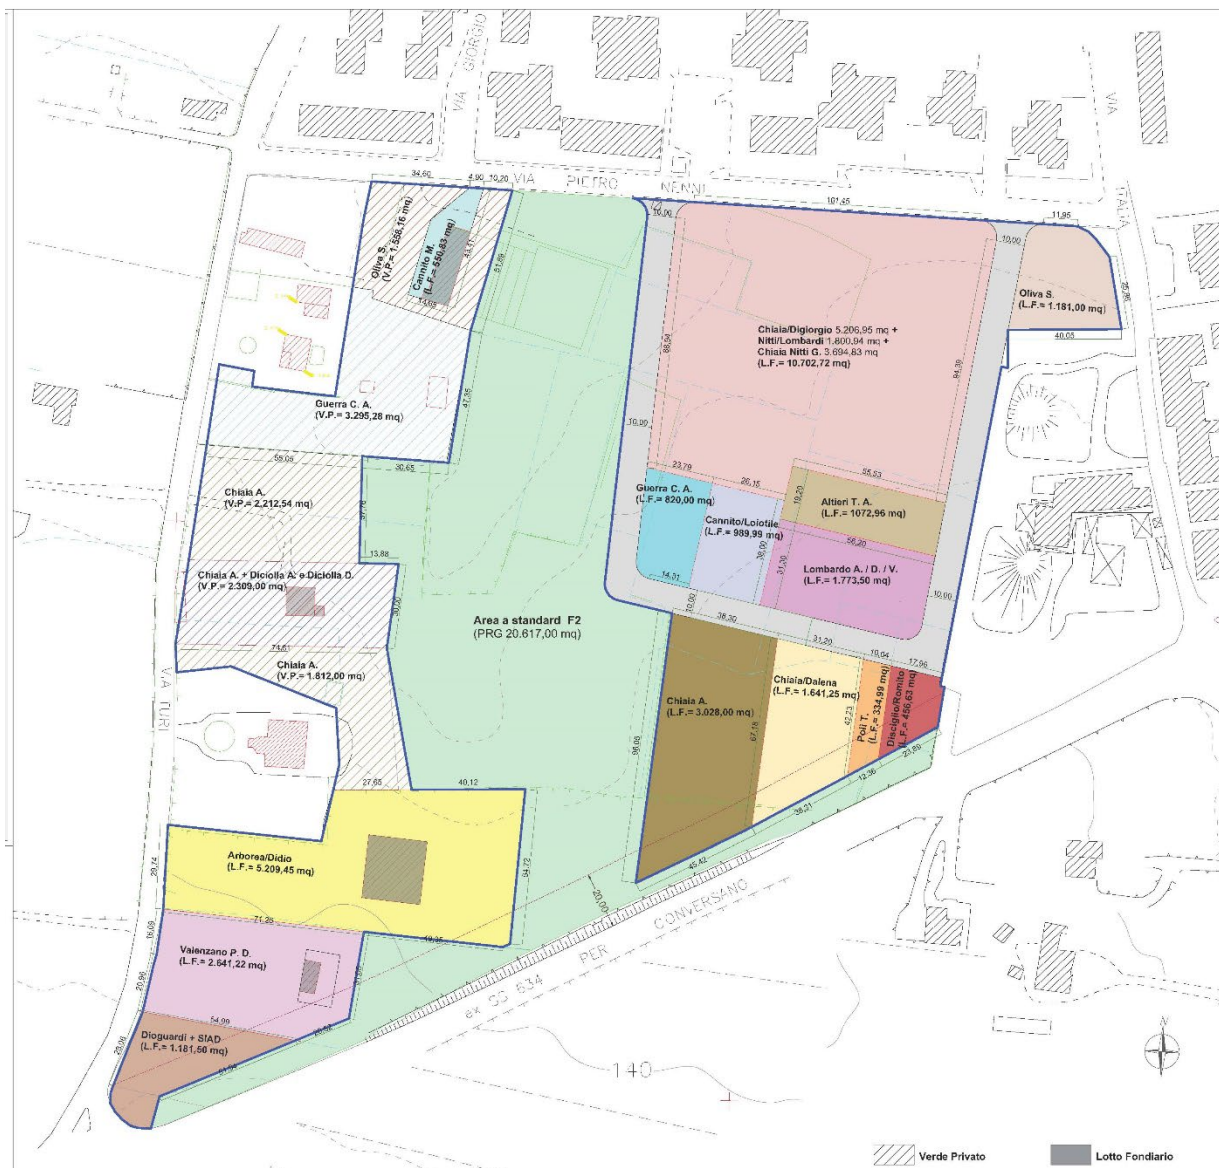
Planimetria generale di progetto: individuazione dei lotti fondiari
